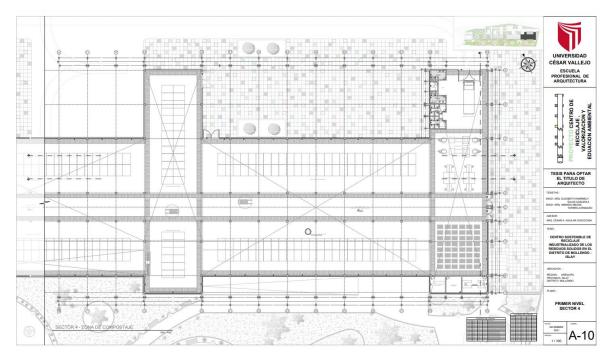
Planta de Distribución, Sector 4 – Primer Nivel FUENTE: Elaboración Propia
